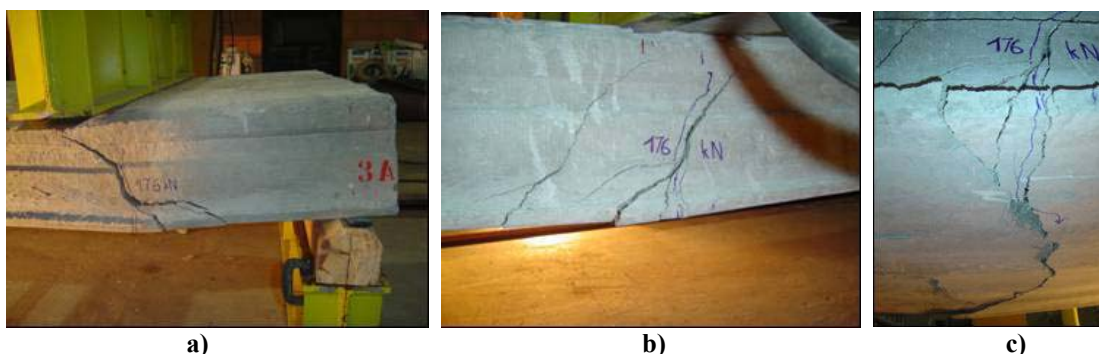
Abertura de fissura da laje L03-20-SC-6_C: a) Vista lateral - lado esquerdo; b) Vista lateral - lado direito; c) Parte inferior da laje.
